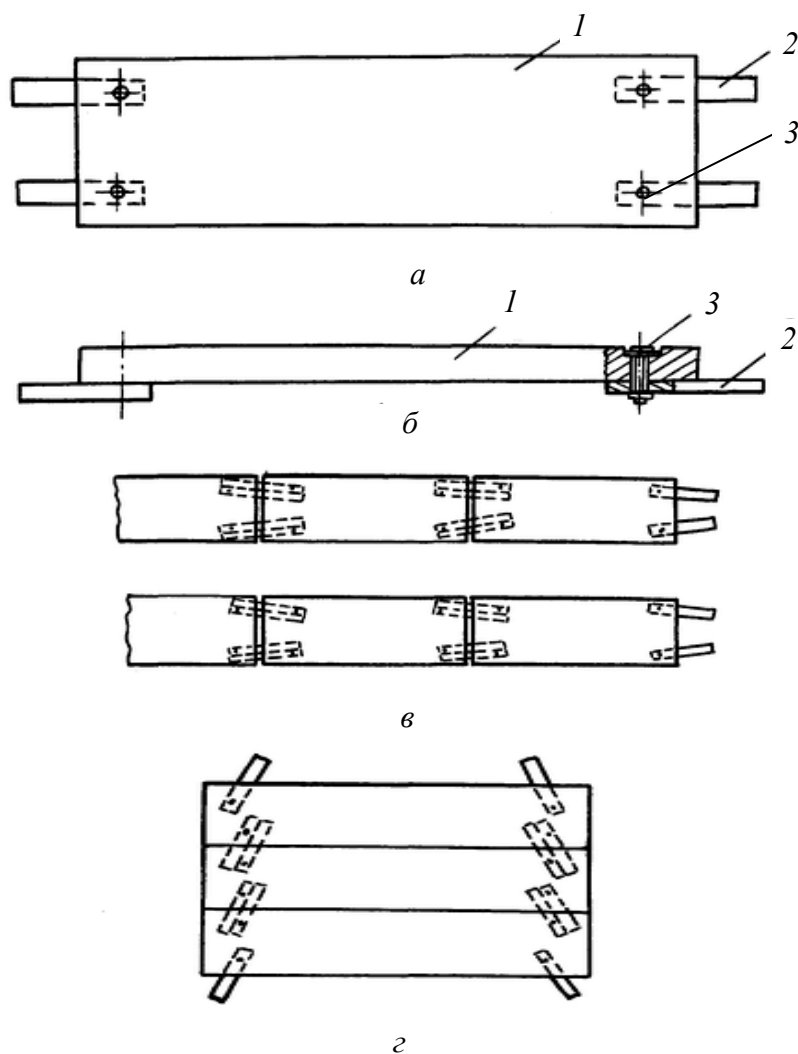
Универсальное покрытие с шарнирными соединительными связями:
